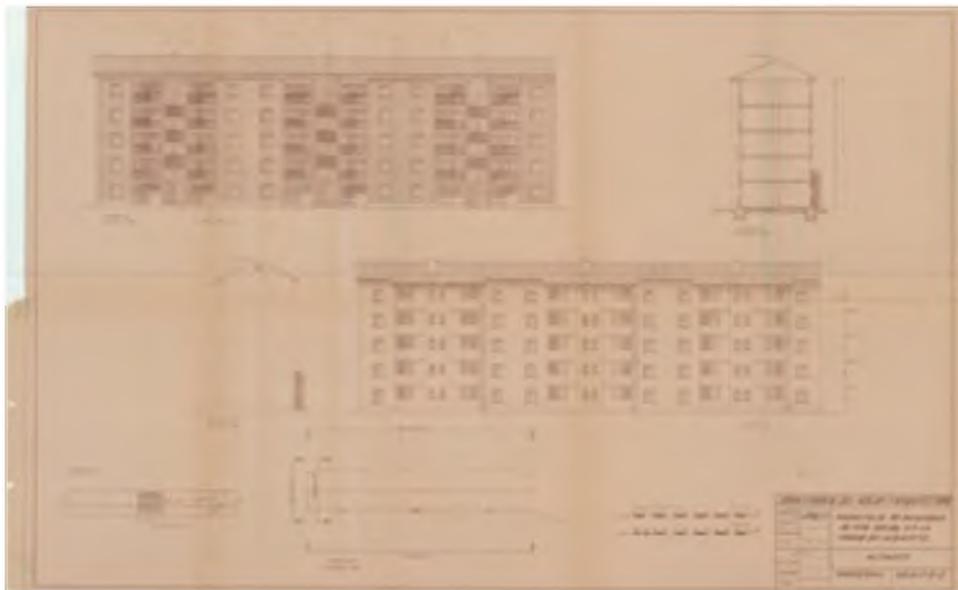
Grupo Lope de Vega. Alzados y sección. Caja nº 89.
